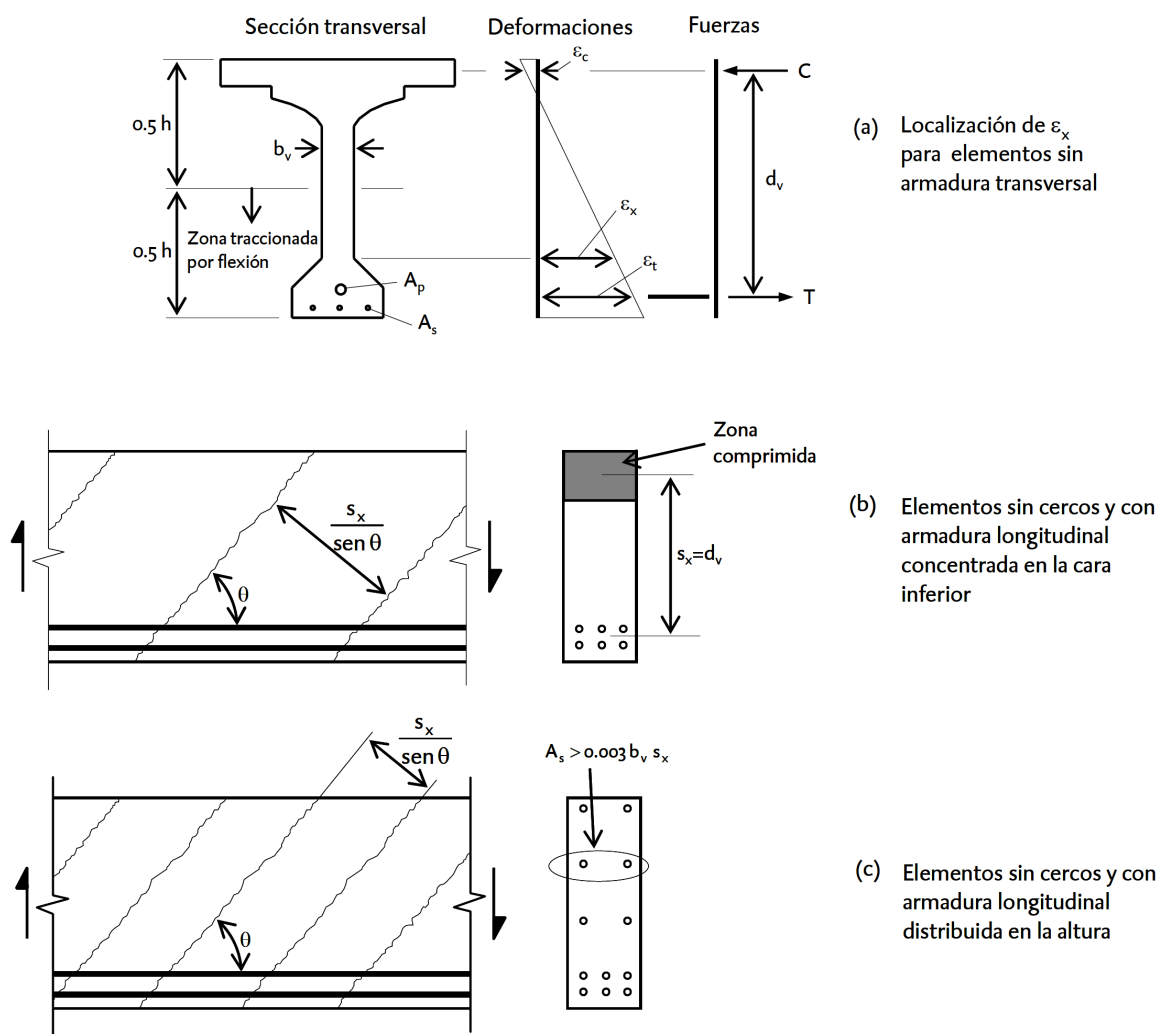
Parámetro de espaciado de fisura.
